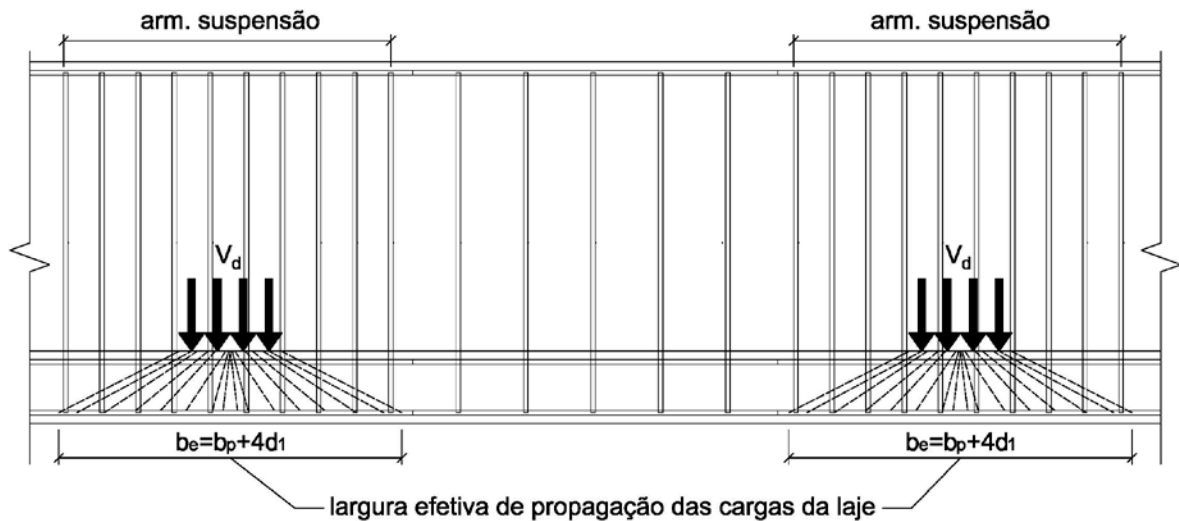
Largura efetiva de propagação das cargas da laje para a alma da viga – vista lateral da viga [adaptado de Collins e Mitchell (1997)].
